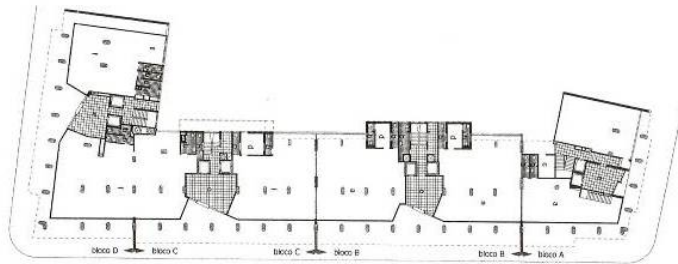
Edifício Esplanada. Planta Baixa Térreo, implantação periférica sobre colunata-galeria preenchendo a testada do quarteirão (Av. Independência à esquerda).
